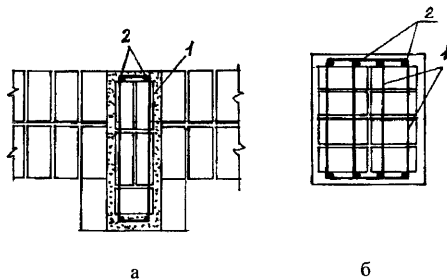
Продольное армирование кирпичных конструкций (стен, столбов и др.): а – расположение арматуры в штрабе кладки; б – наружное расположение арматуры; 1 – поперечные хомуты; 2 – продольная арматура
